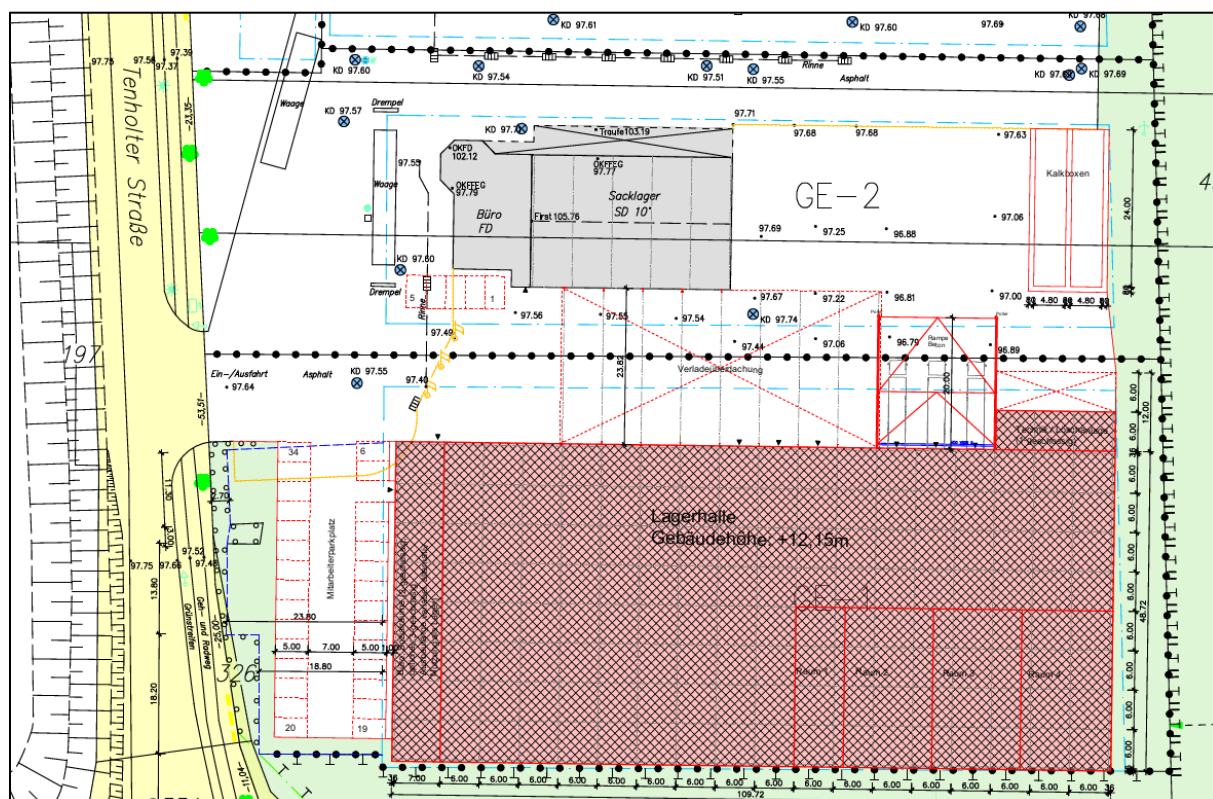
Neubau einer Lagerhalle, Lageplan (Vorentwurf), AGRAVIS Raiffeisen AG, Projektbau, Münster (Auszug), Stand: 16.06.2023
